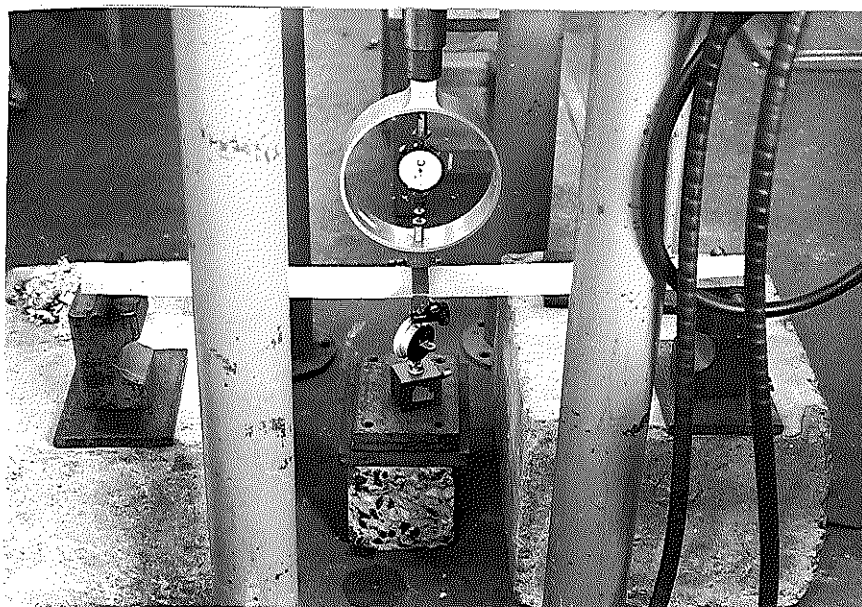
Ensaio de Flexão - Equipamento de Carga: Anel Dinamométrico e Cilindro Hidráulico.
